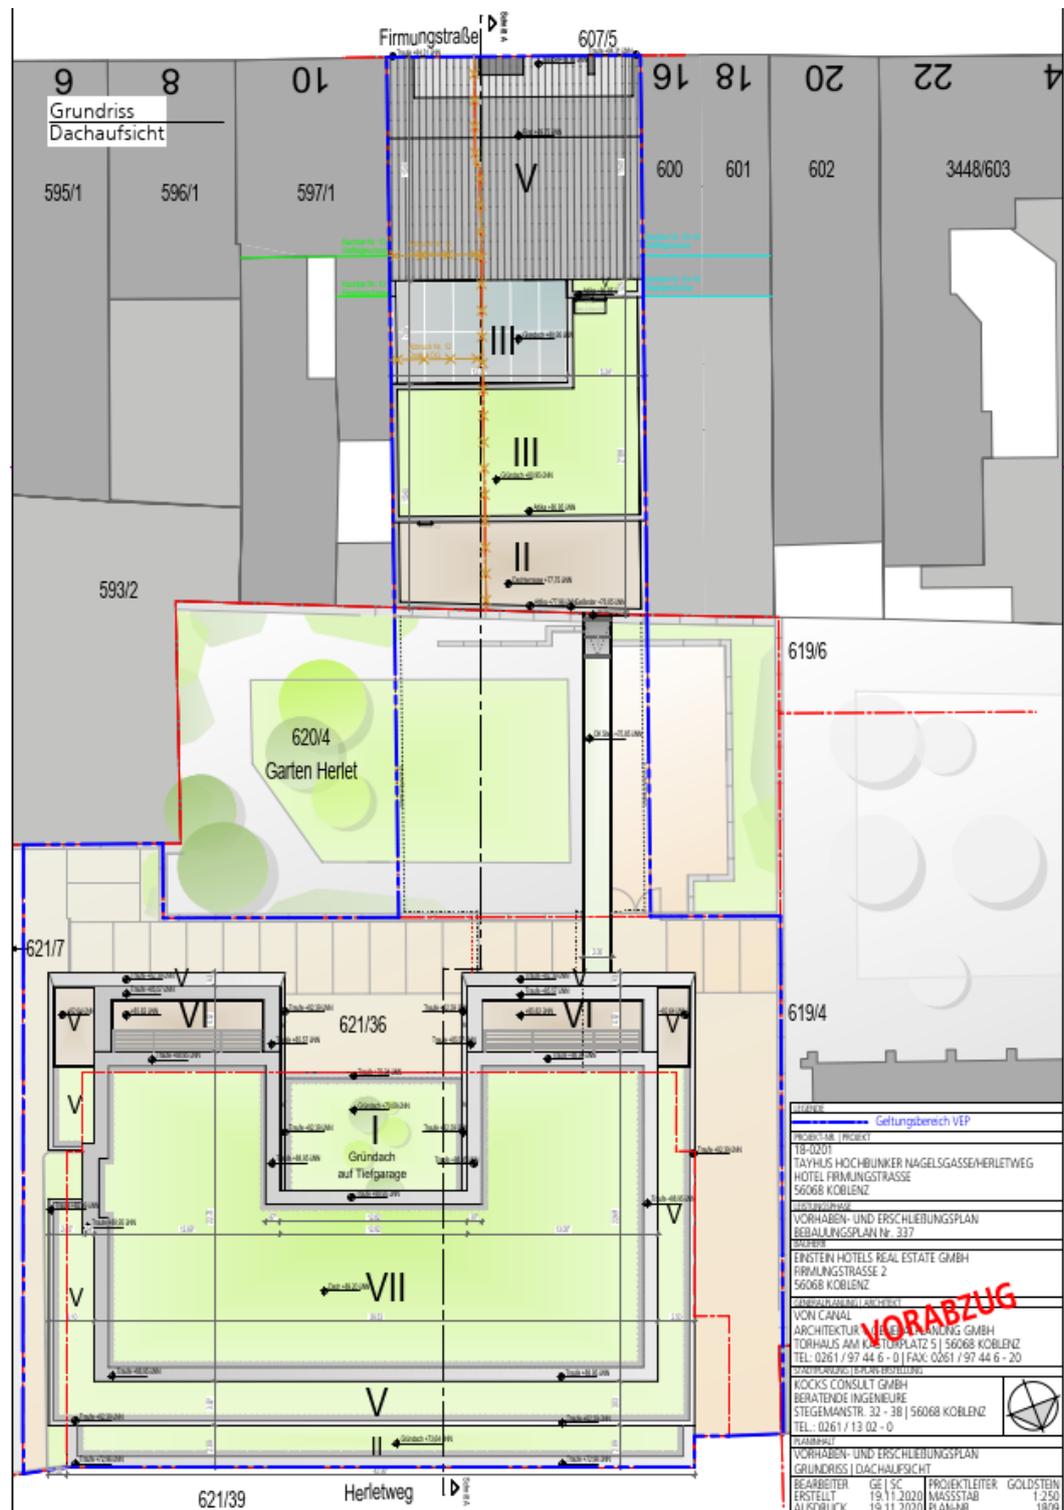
Dachaufsichtsplan Vorhaben Hotel
